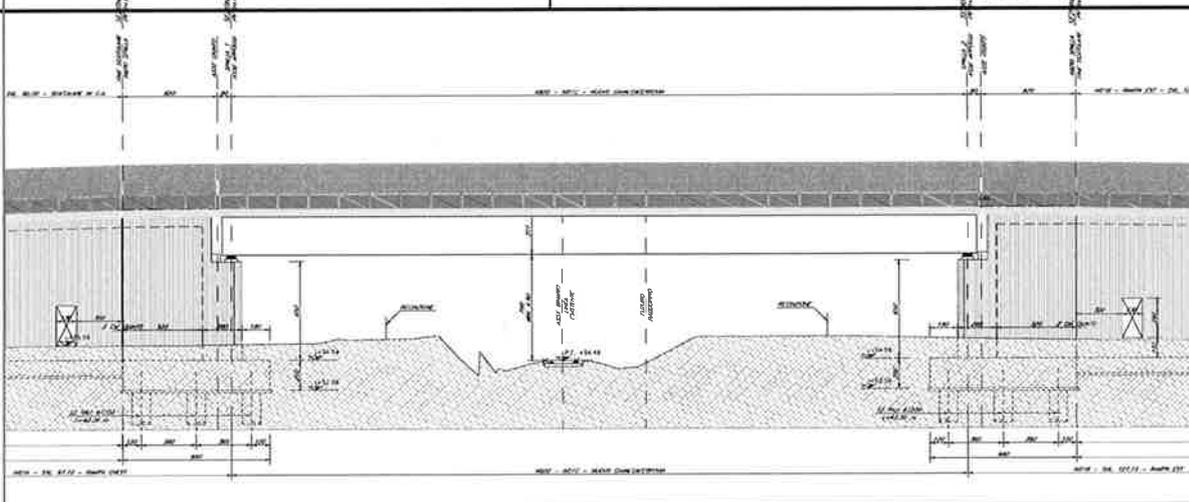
Prospetto longitudinale cavalcaferrovia: campata di scavalco
